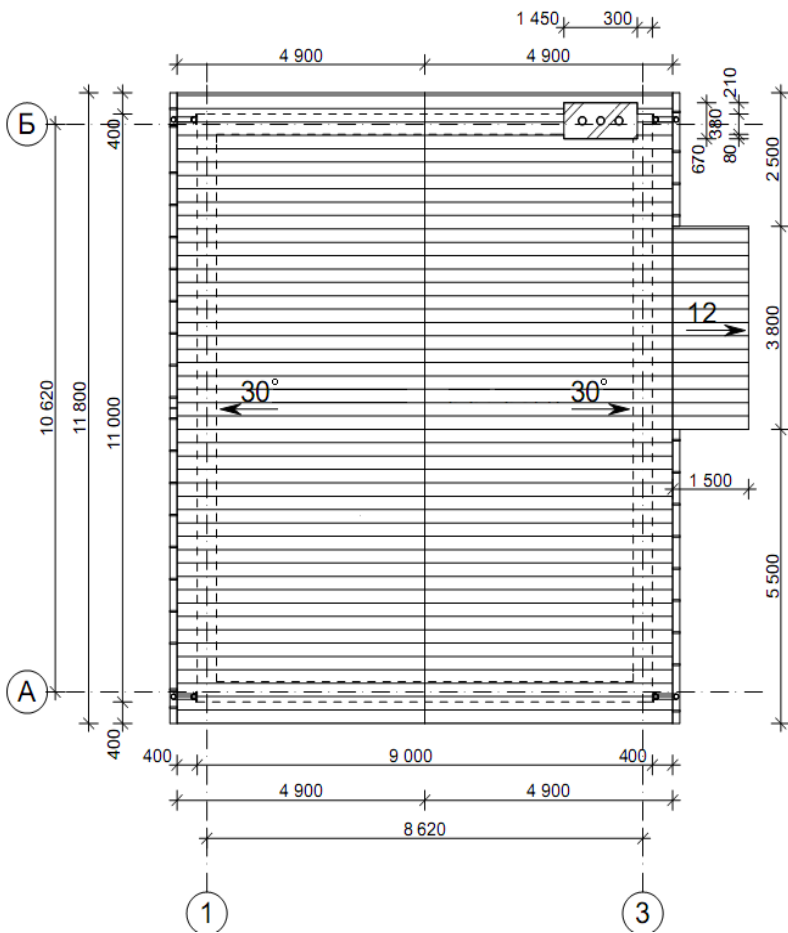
Пример оформления плана кровли малоэтажного жилого дома
